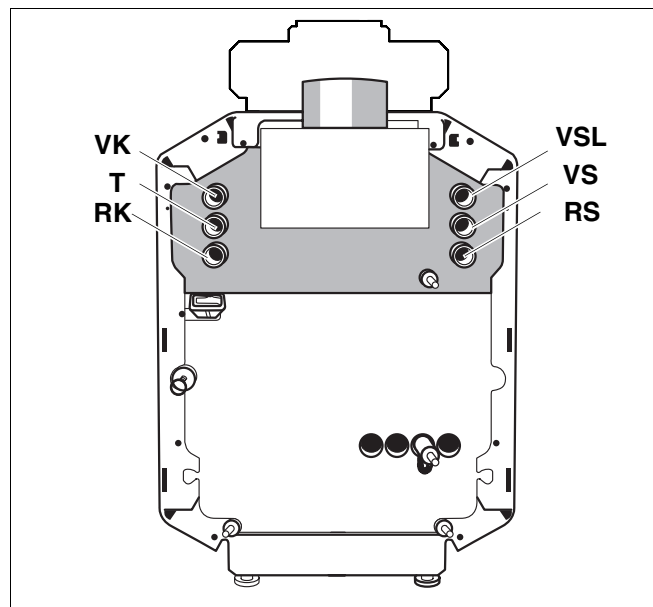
Rückansicht; Anschlüsse wie Lieferzustand
